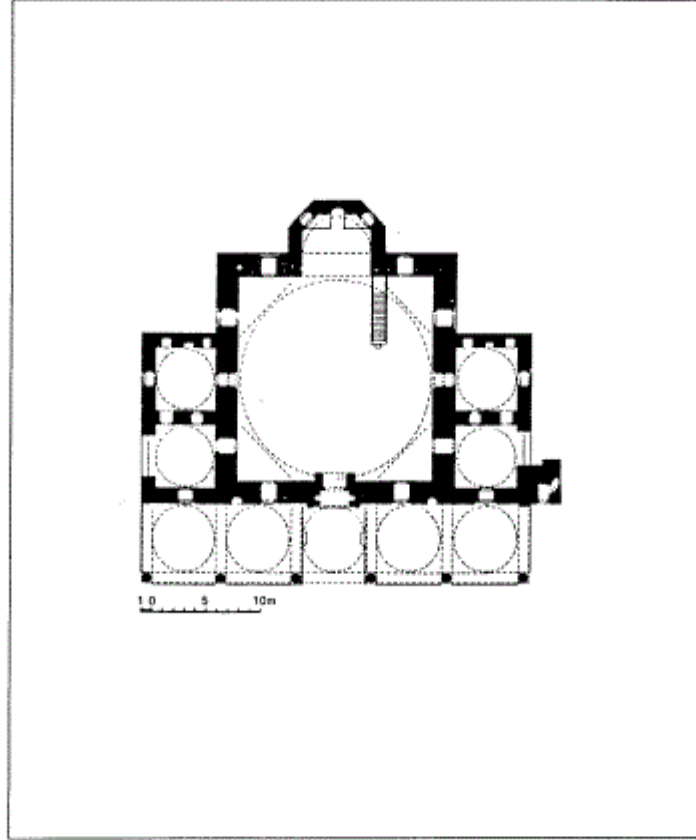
مسقط أفقي لمسجد حاجي شهاب الدين باشا في أدرنة (عن : كوران) .
